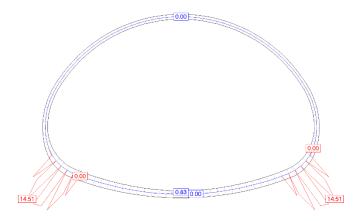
Secção VR1.5. Armaduras de cálculo de flexão (cm2/m)
